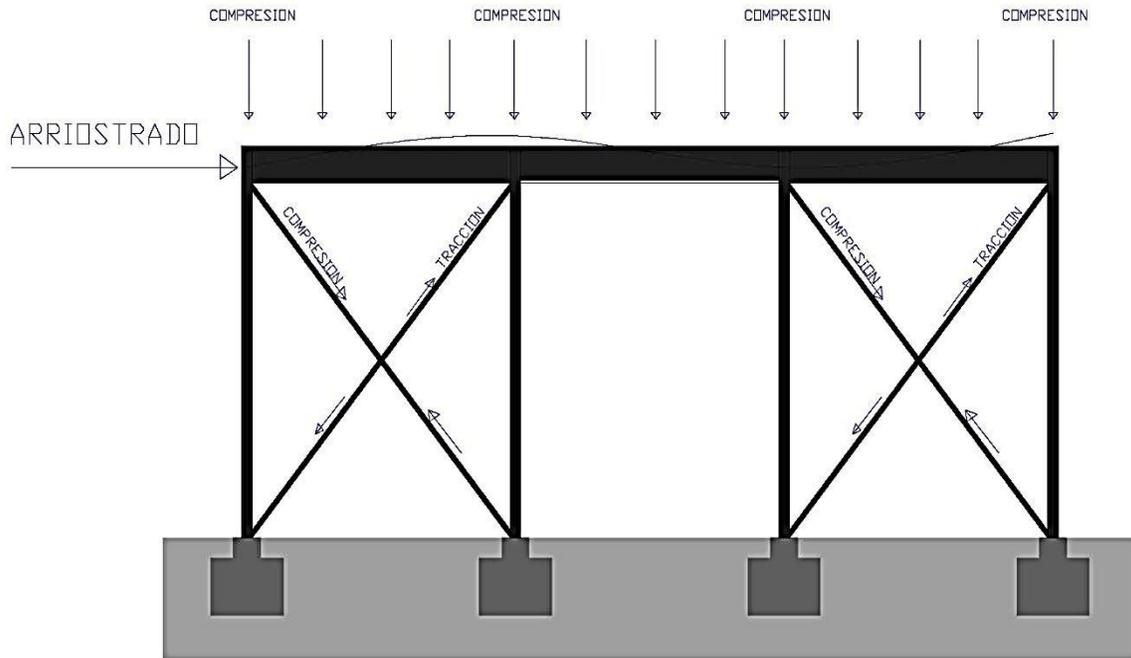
Esquema comportamiento estructural Arriostrado
